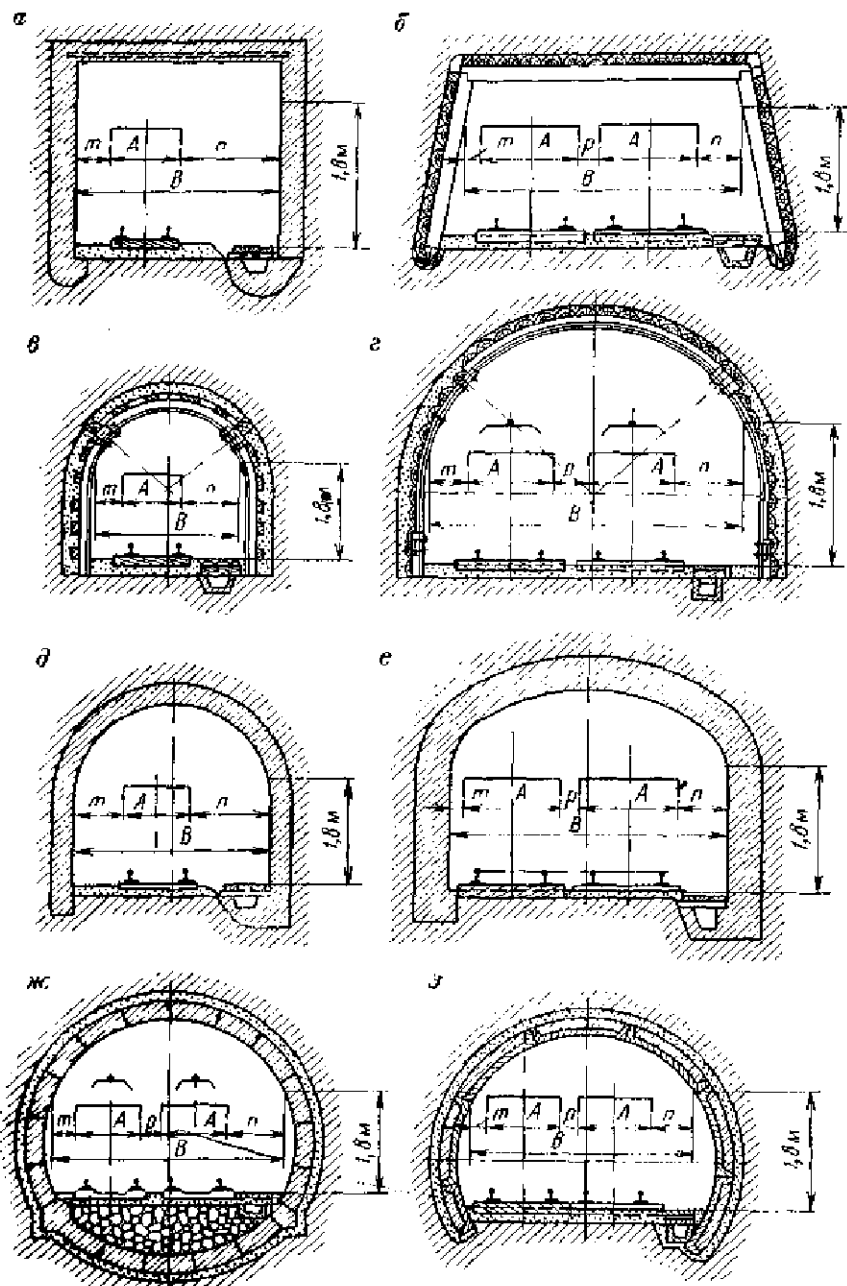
Формы поперечного сечения горных выработок: а – прямоугольная; б – трапециевидная; в, г, д – арочная; е – сводчатая; ж – круглая; з – полигональная.
